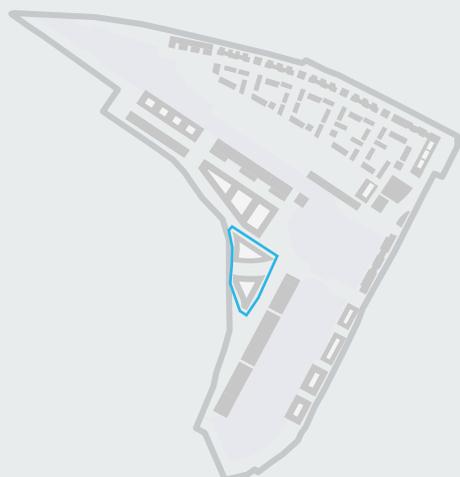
Lageplan Baufelder 30 (oben) und 31 (unten)
